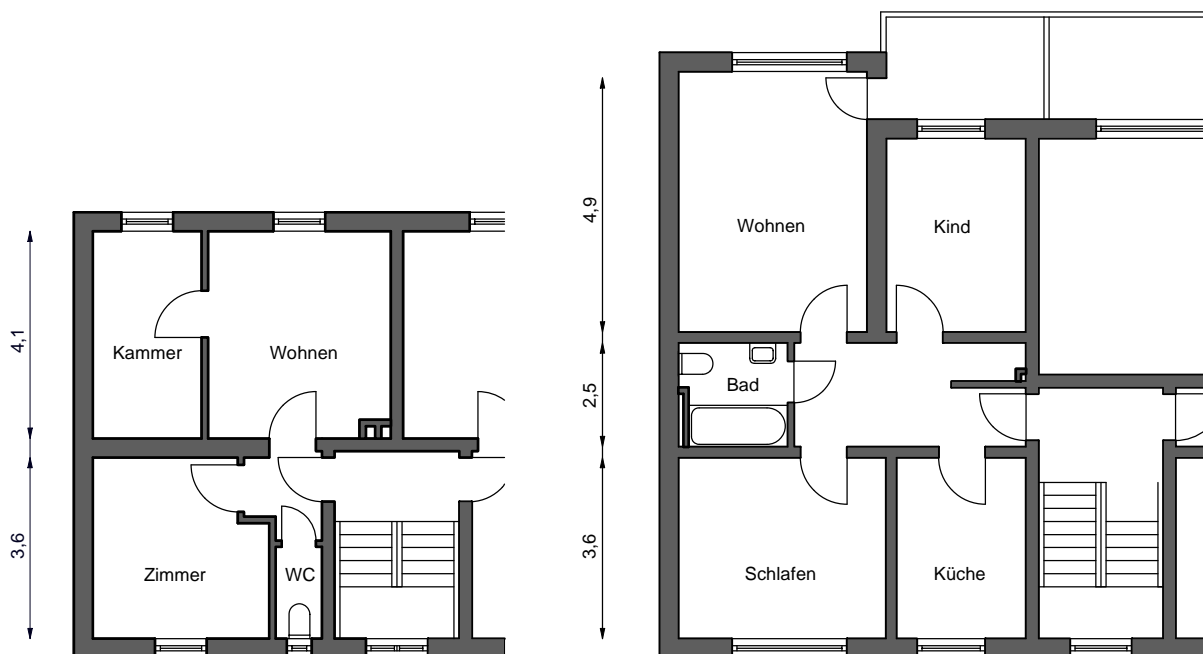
Grundrissentwicklung; Wohnungsgrundriss ca. 1930 (links) und moderner Wohnungsgrundriss mit innenliegendem Bad [12]
